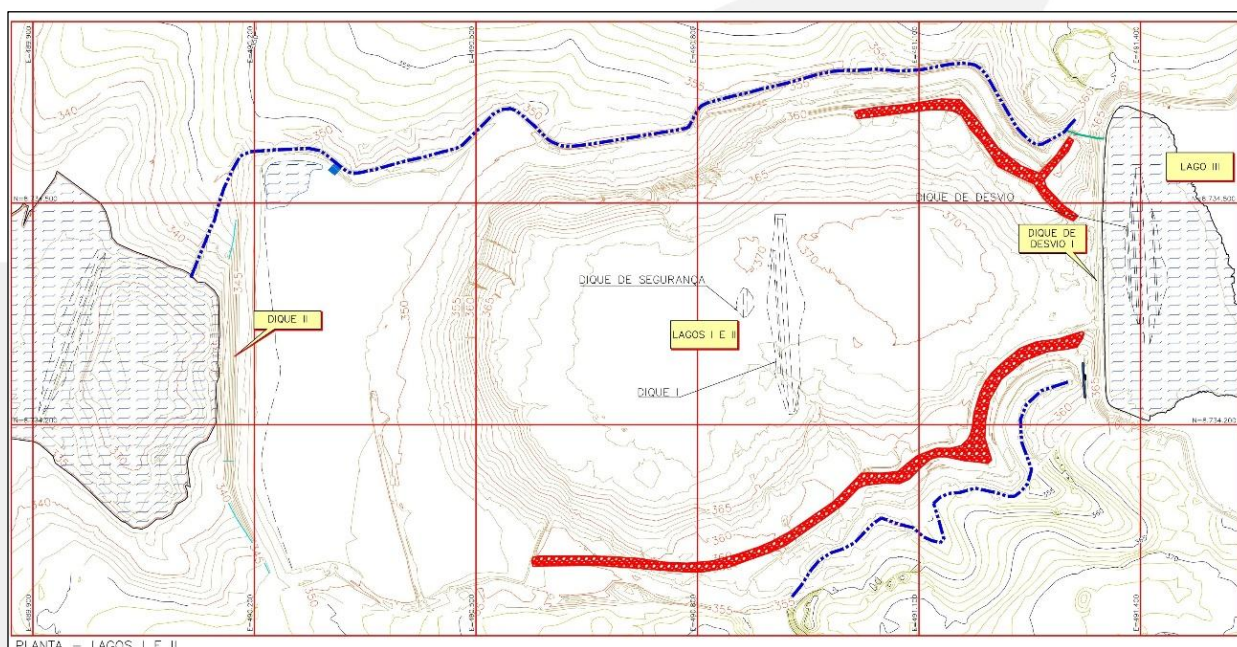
Planta com o arranjo geral do Lago I-II (Fonte: GGC, 2020)
